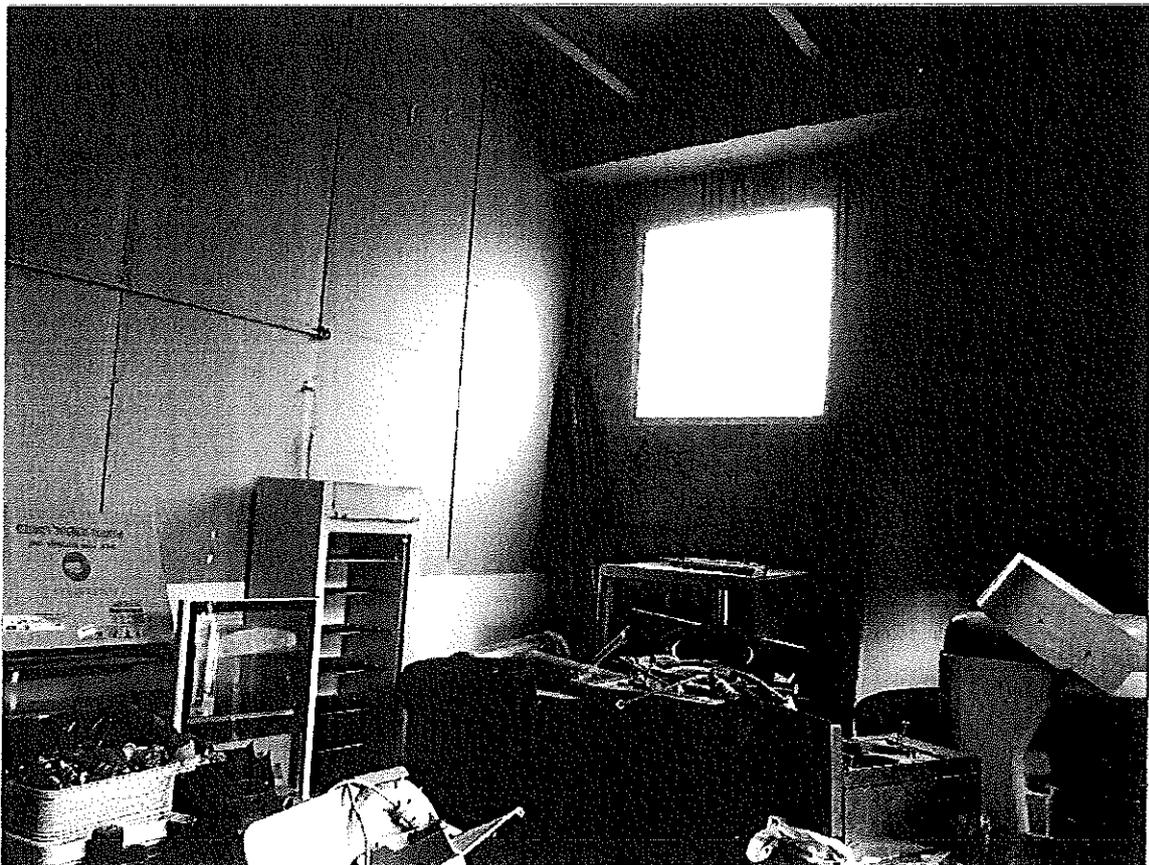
Manufatto precario aderente alle pareti Nord e Est dell'opificio – Interno
